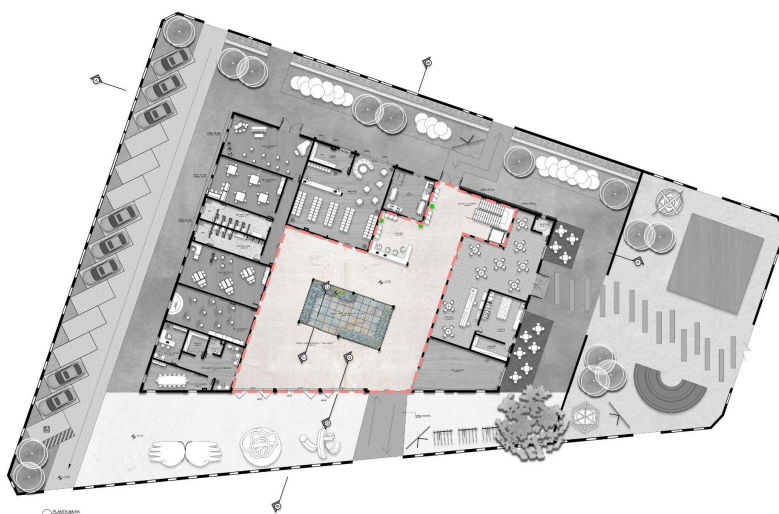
Planta baixa do projeto. Fonte: da autora.
